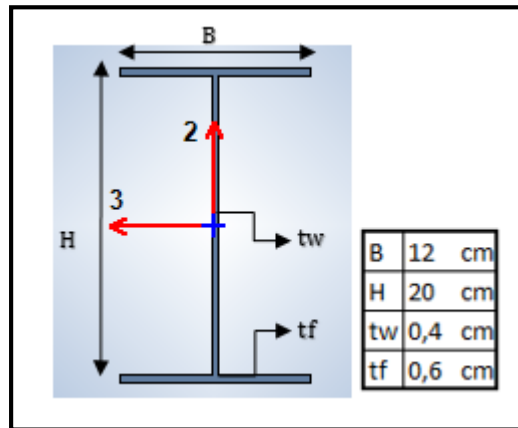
Dimensiones de Viga secundaria 1 con pórticos arriostrados.
